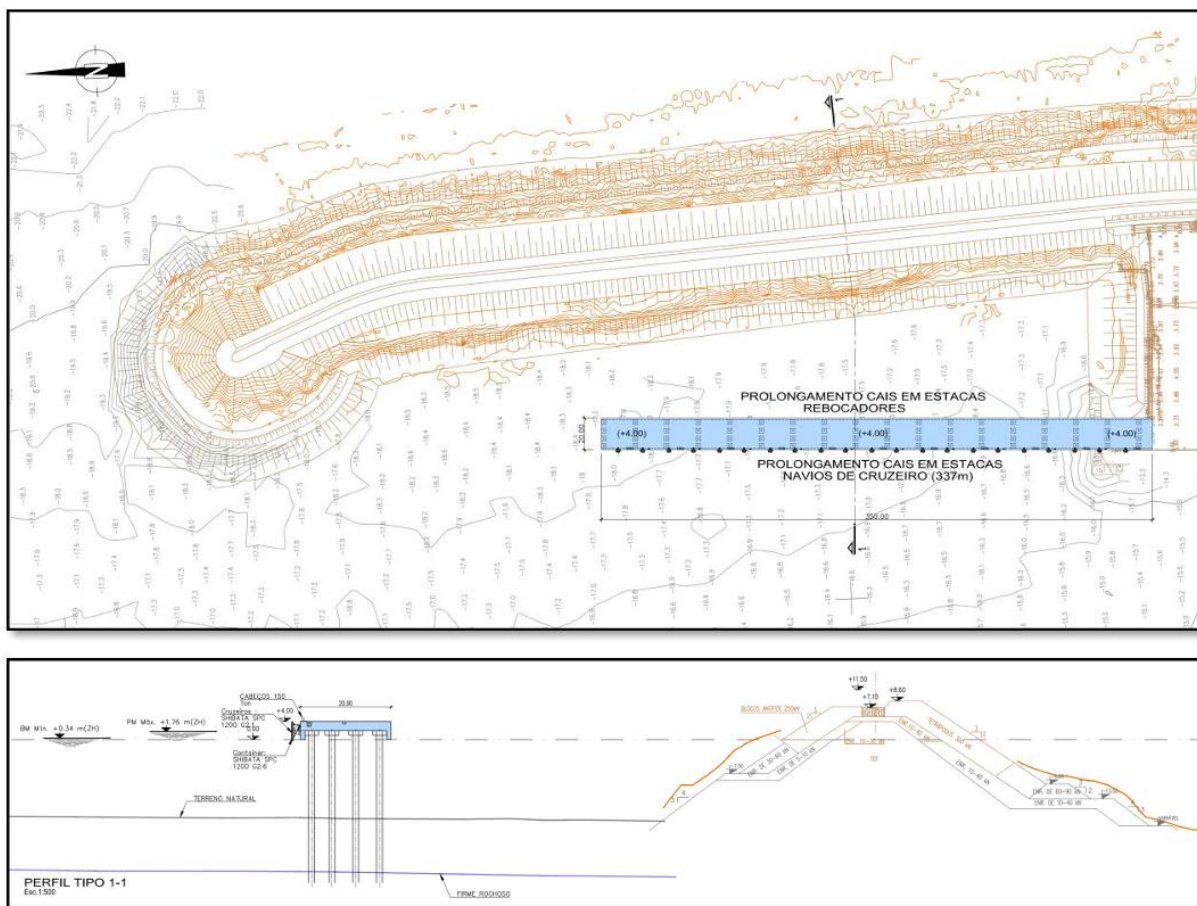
Prolongamento do cais existente à -12m (ZH) – SOLUÇÃO 1 (planta e perfil tipo) (Desenho obtido do Estudo Prévio).
